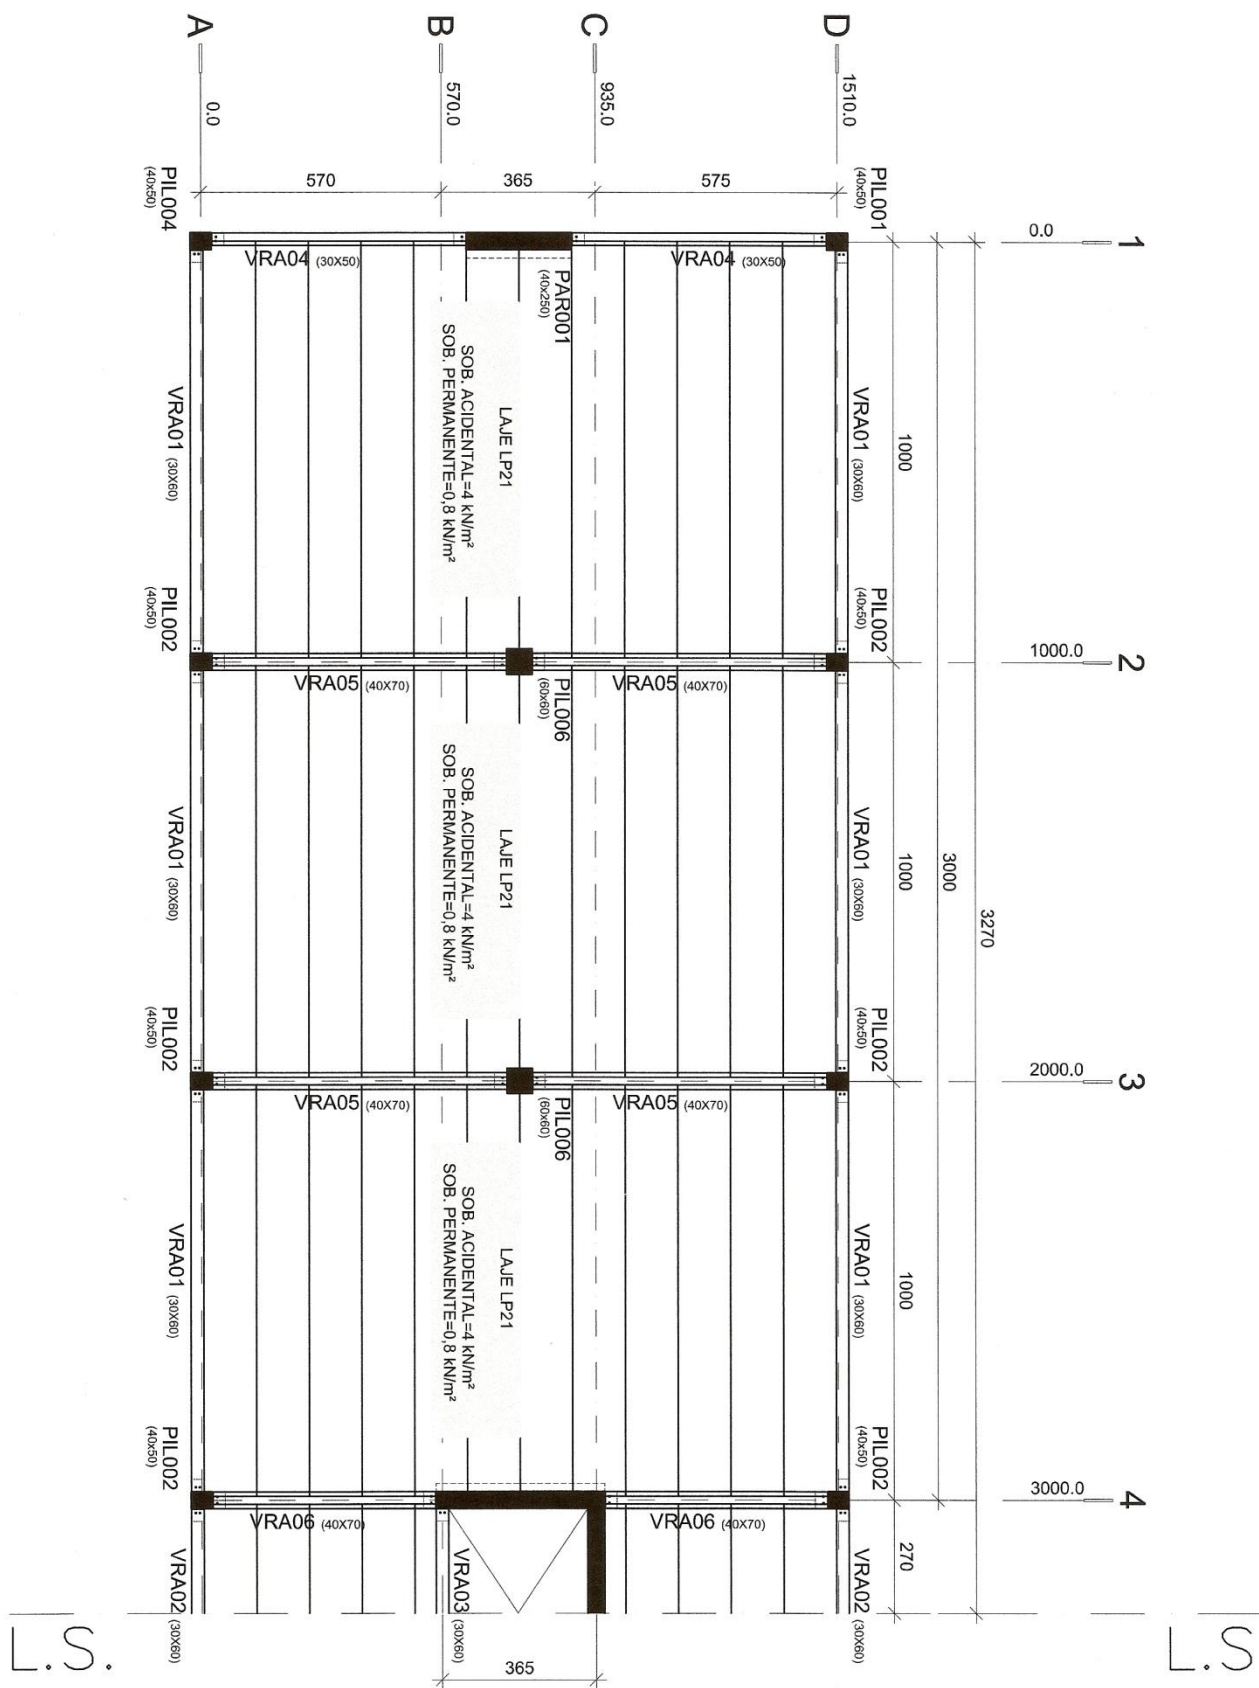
28 – Planta de formas do sétimo pavimento da estrutura a ser analisada.
